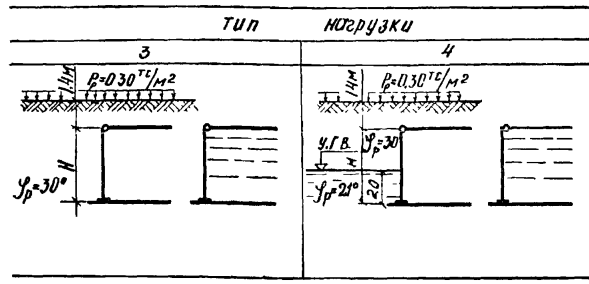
Схемы расчетных нагрузок на балочные стены закрытых сооружений высотой 3,6 и 4,8 м.
